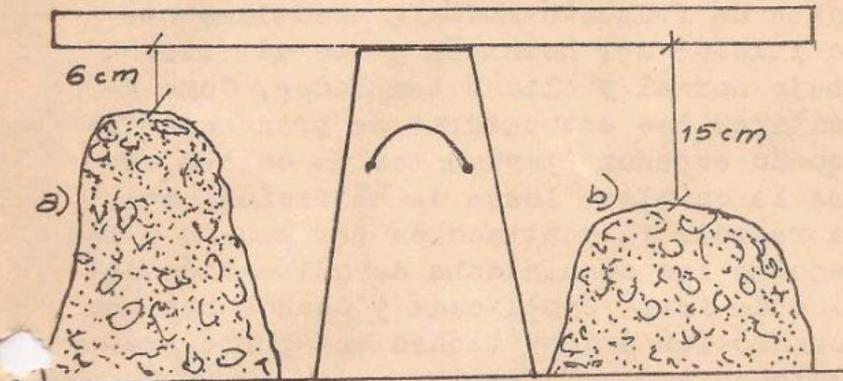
a) HORMIGÓN SIN ADITIVO
